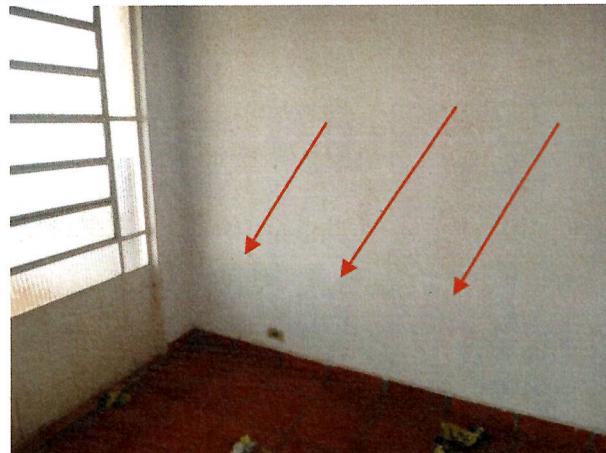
Sinais de infiltrações na parede lateral esquerda do abrigo de veículos
